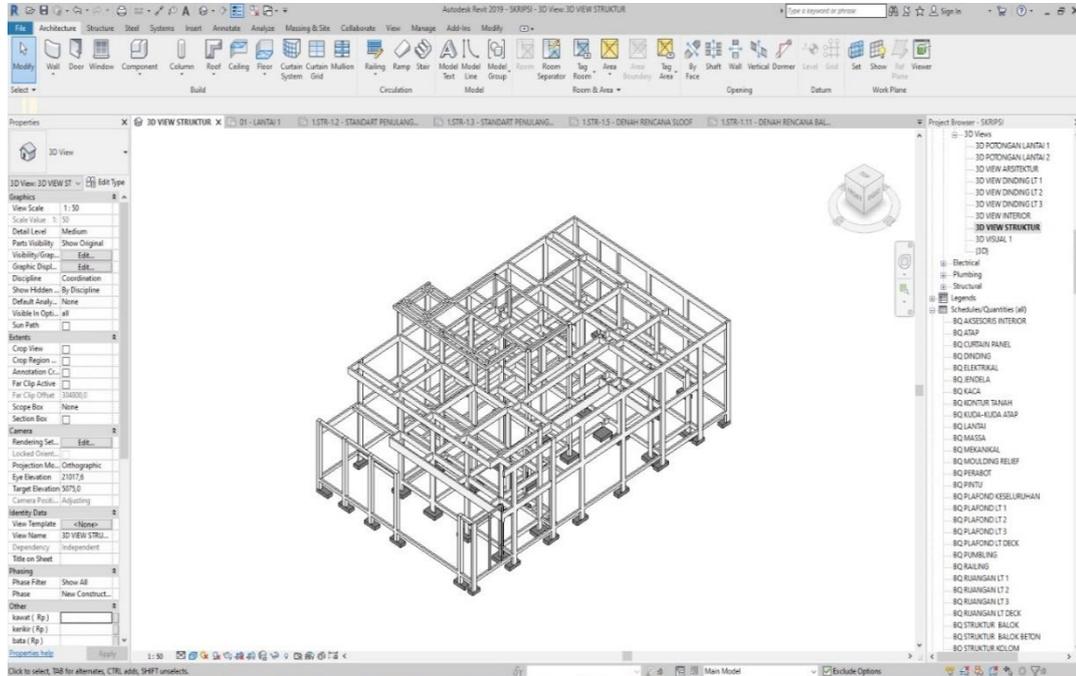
Tampilan Memasukkan Struktur Kolom dan Balok Kedalam Permodelan
